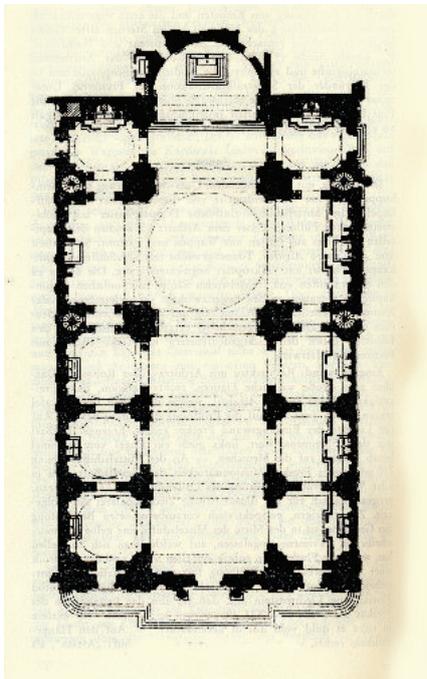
S. Ignazio, Grundriss, Rom.
